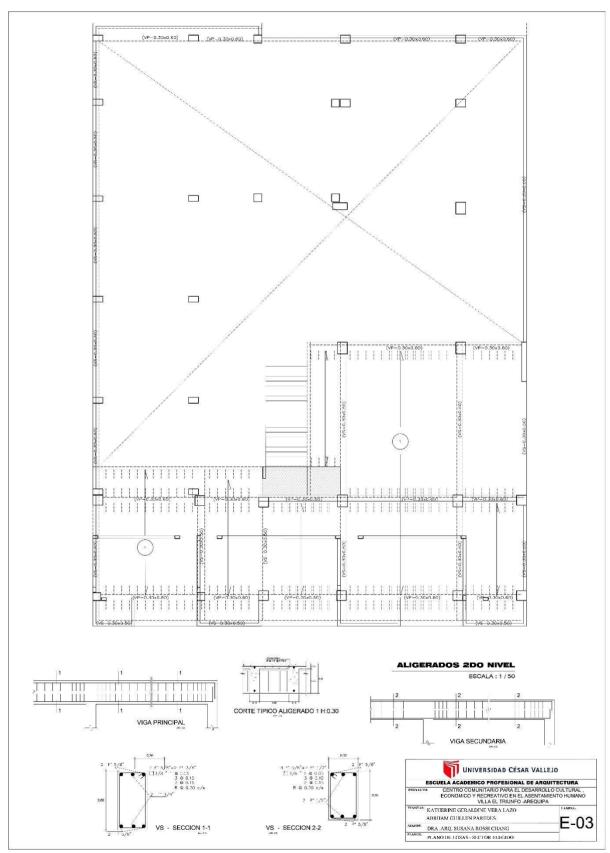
Plano de aligerados Segundo nivel - Elaboración propia
